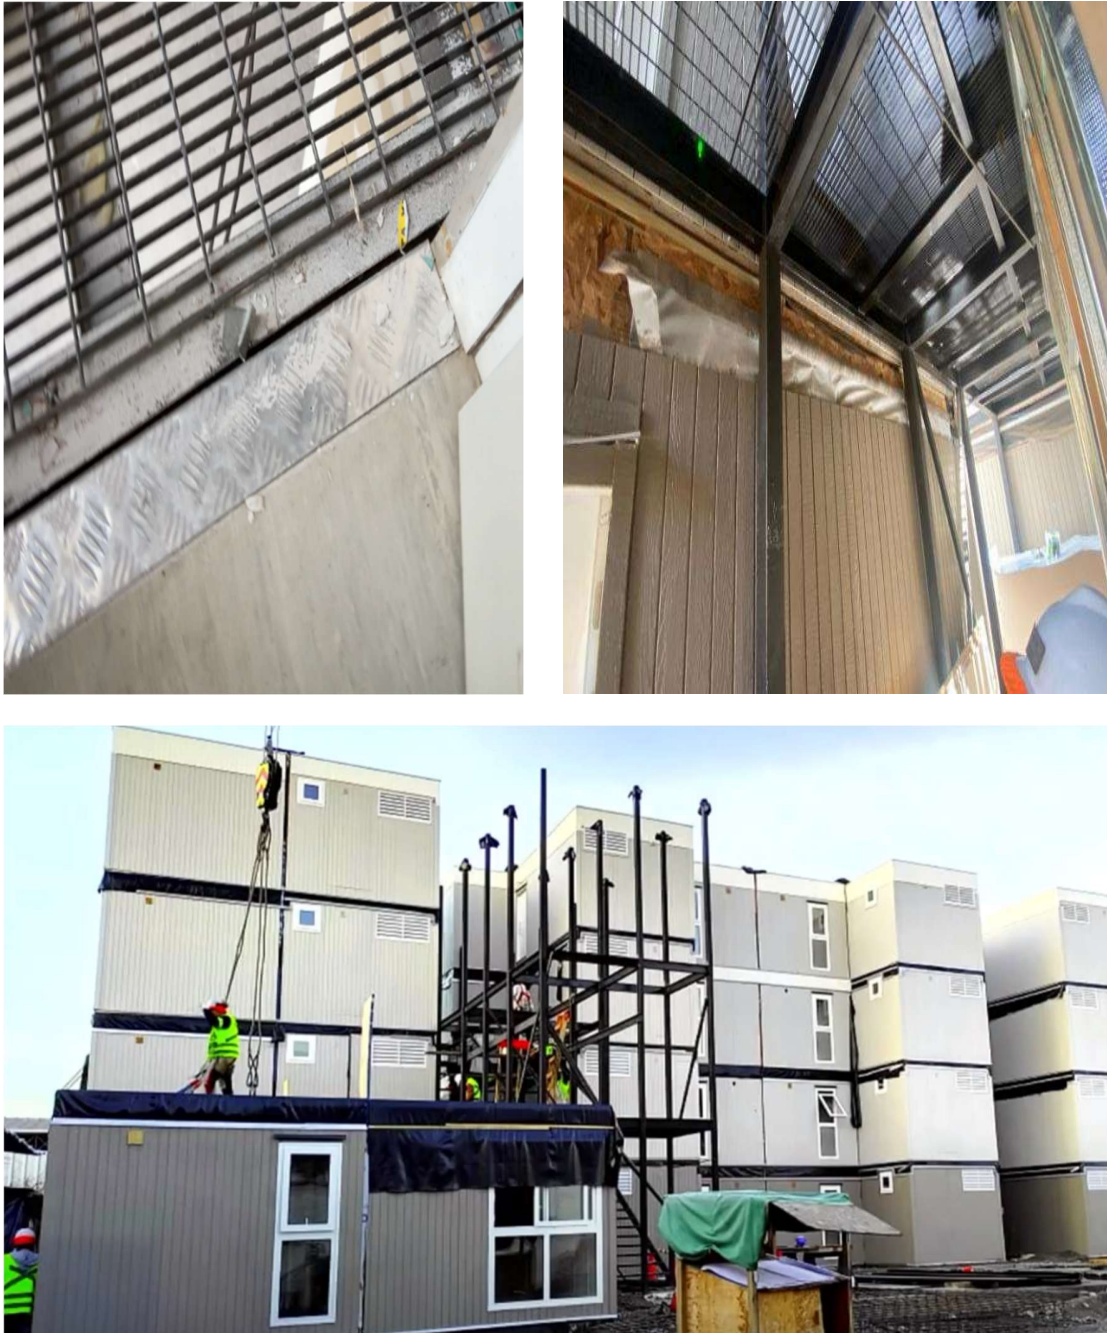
Detalle unión modular - estructura pasillos metálicos. Fuente: Elaboración Propia
